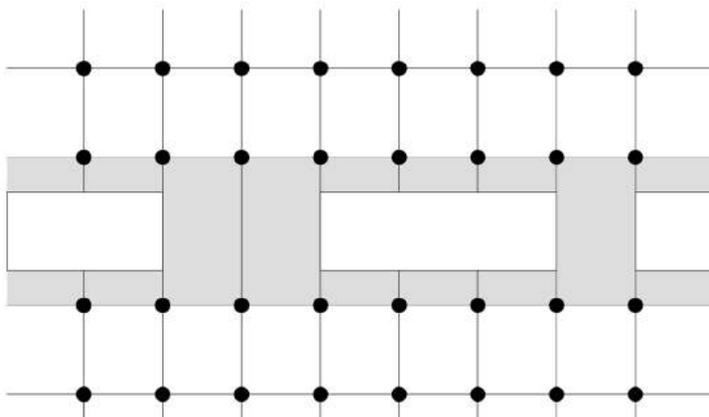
Systemgrundriss, einbündige Anlage mit Flur
